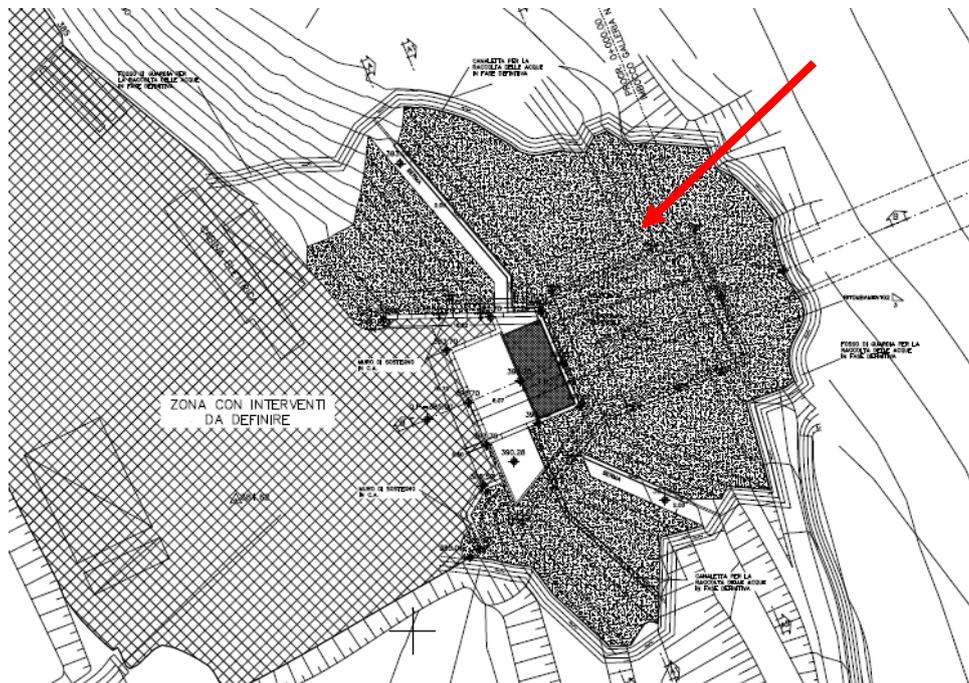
Stralcio planimetrico dell'imbocco della finestra. La freccia rossa indica la zona di ritombamento
